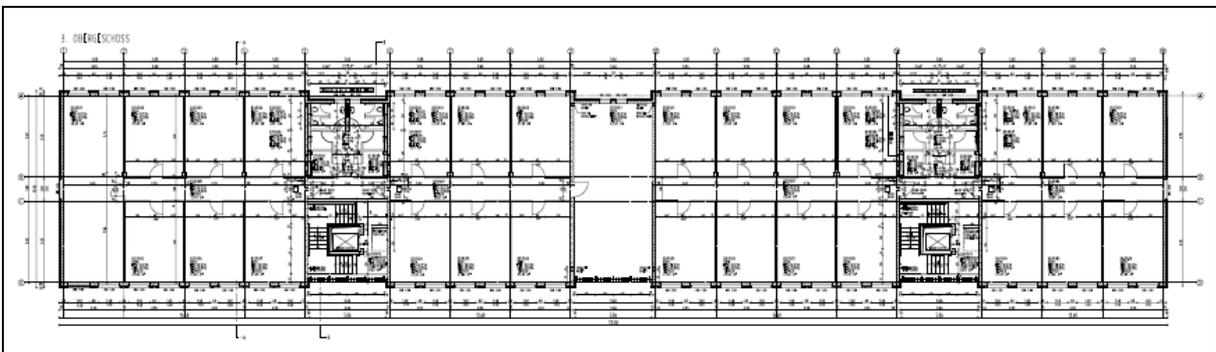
Geschossdecken des Musterbürogebäudes (3. Obergeschoss)
